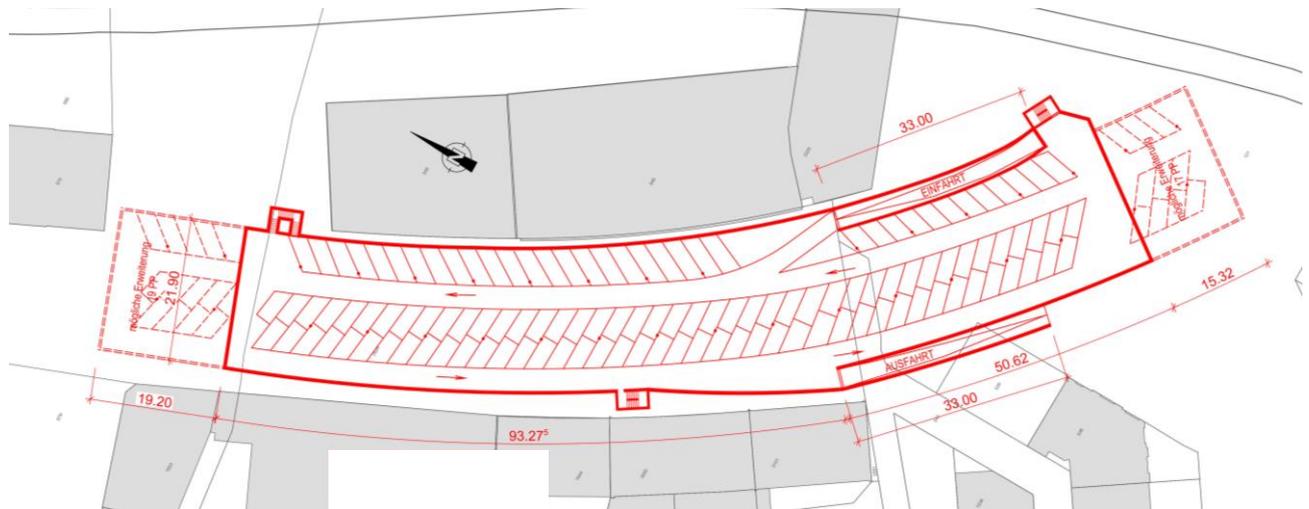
Ausschnitt Situation Variante Hallwiler 1.2 Grundriss Parkgeschoss
